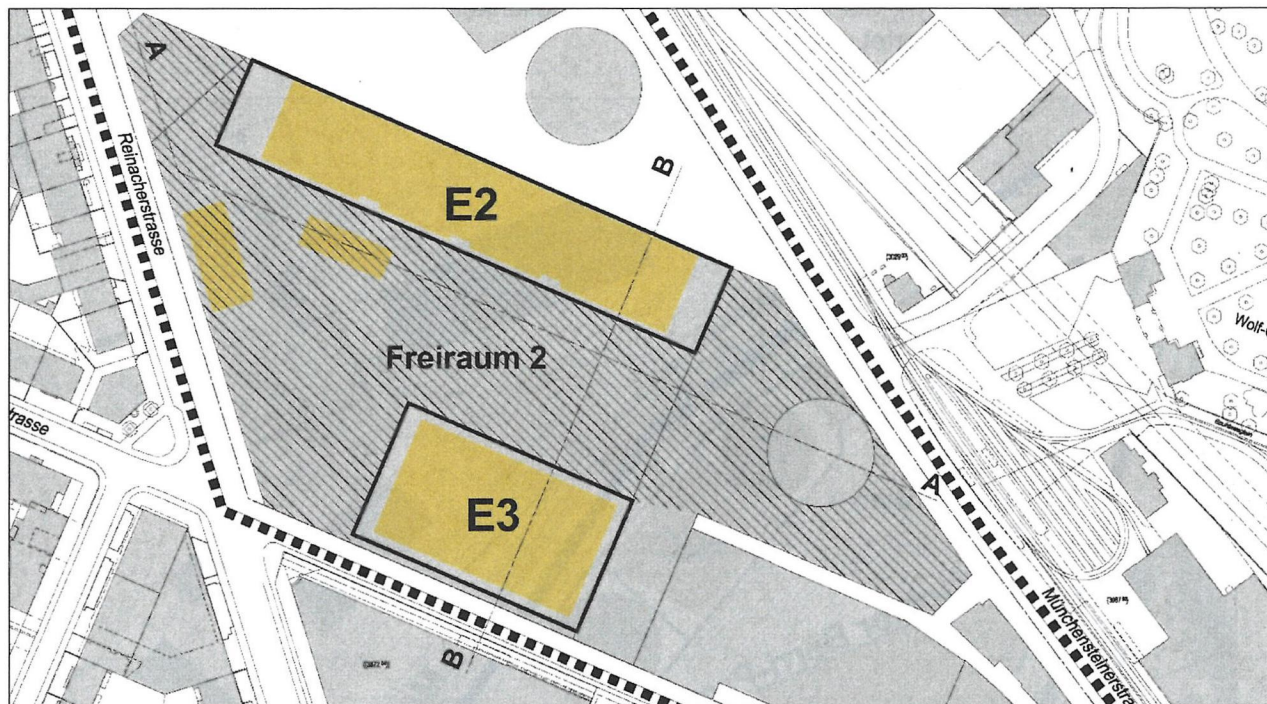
Entwurf Bebauungsplan Aufsicht Baufeld E1 / 3. Obergeschoss. Dargestellt sind die Baufelder E2 und E3 sowie der Freiraum 2.
